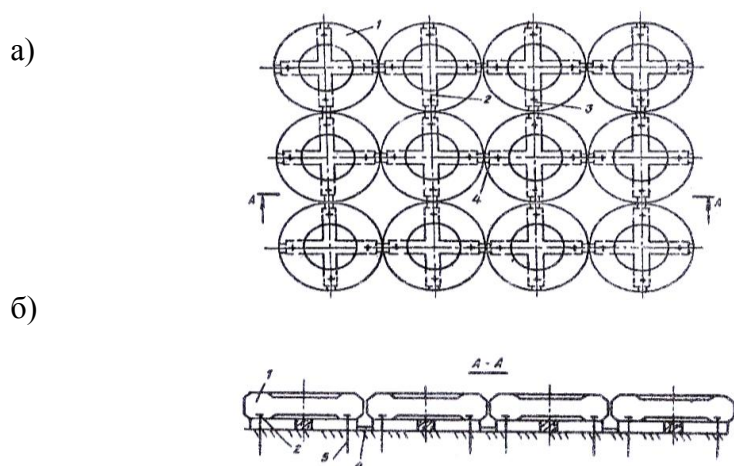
Противоэрозионное покрытие откосов (а.с. СССР№1231110): а) вид сверху; б) разрез А-А; 1- покрывки; 2-железобетонные крестообразные элементы; 3-болтовые соединения; 4-арматурные выпуски; 5-шпильки.
